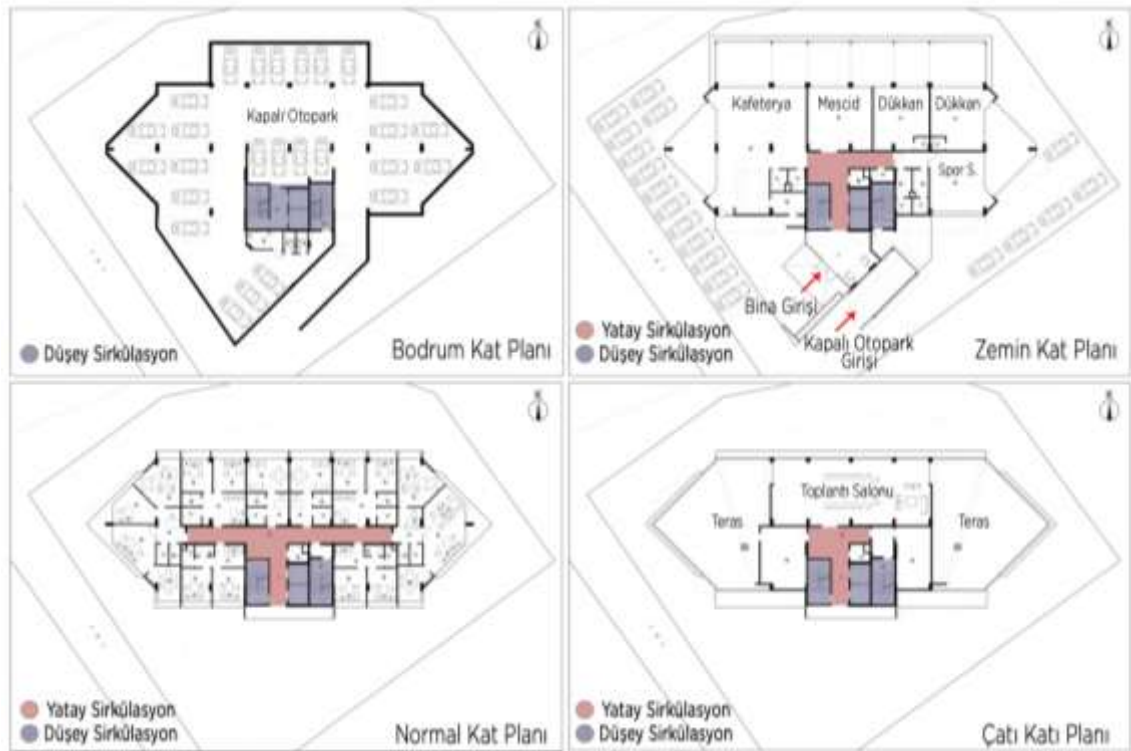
ÇKA Hizmet Binaları Zemin Kat Planı [103]
